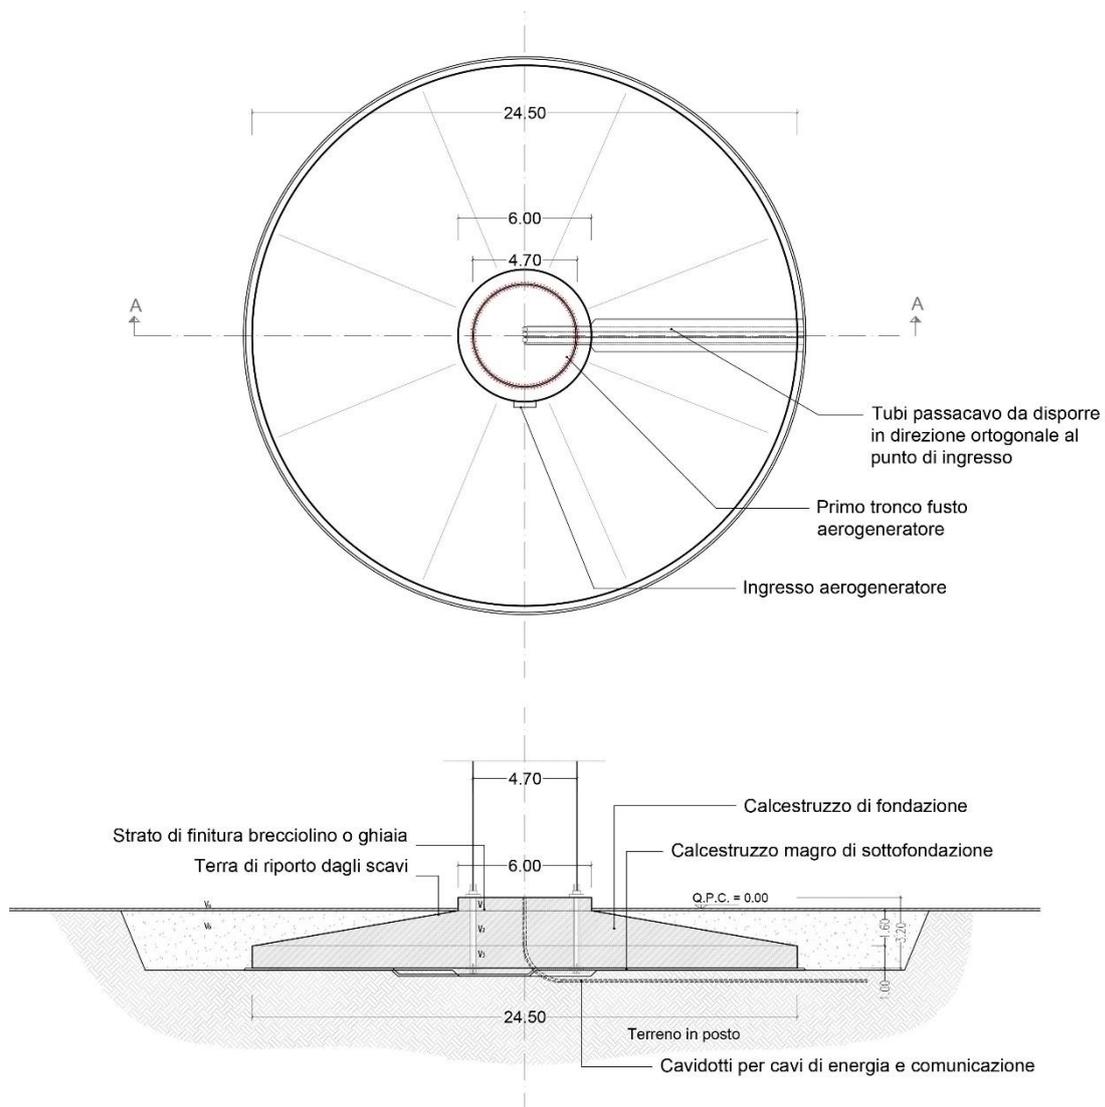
Pianta e vista della fondazione tipo dell'aerogeneratore
